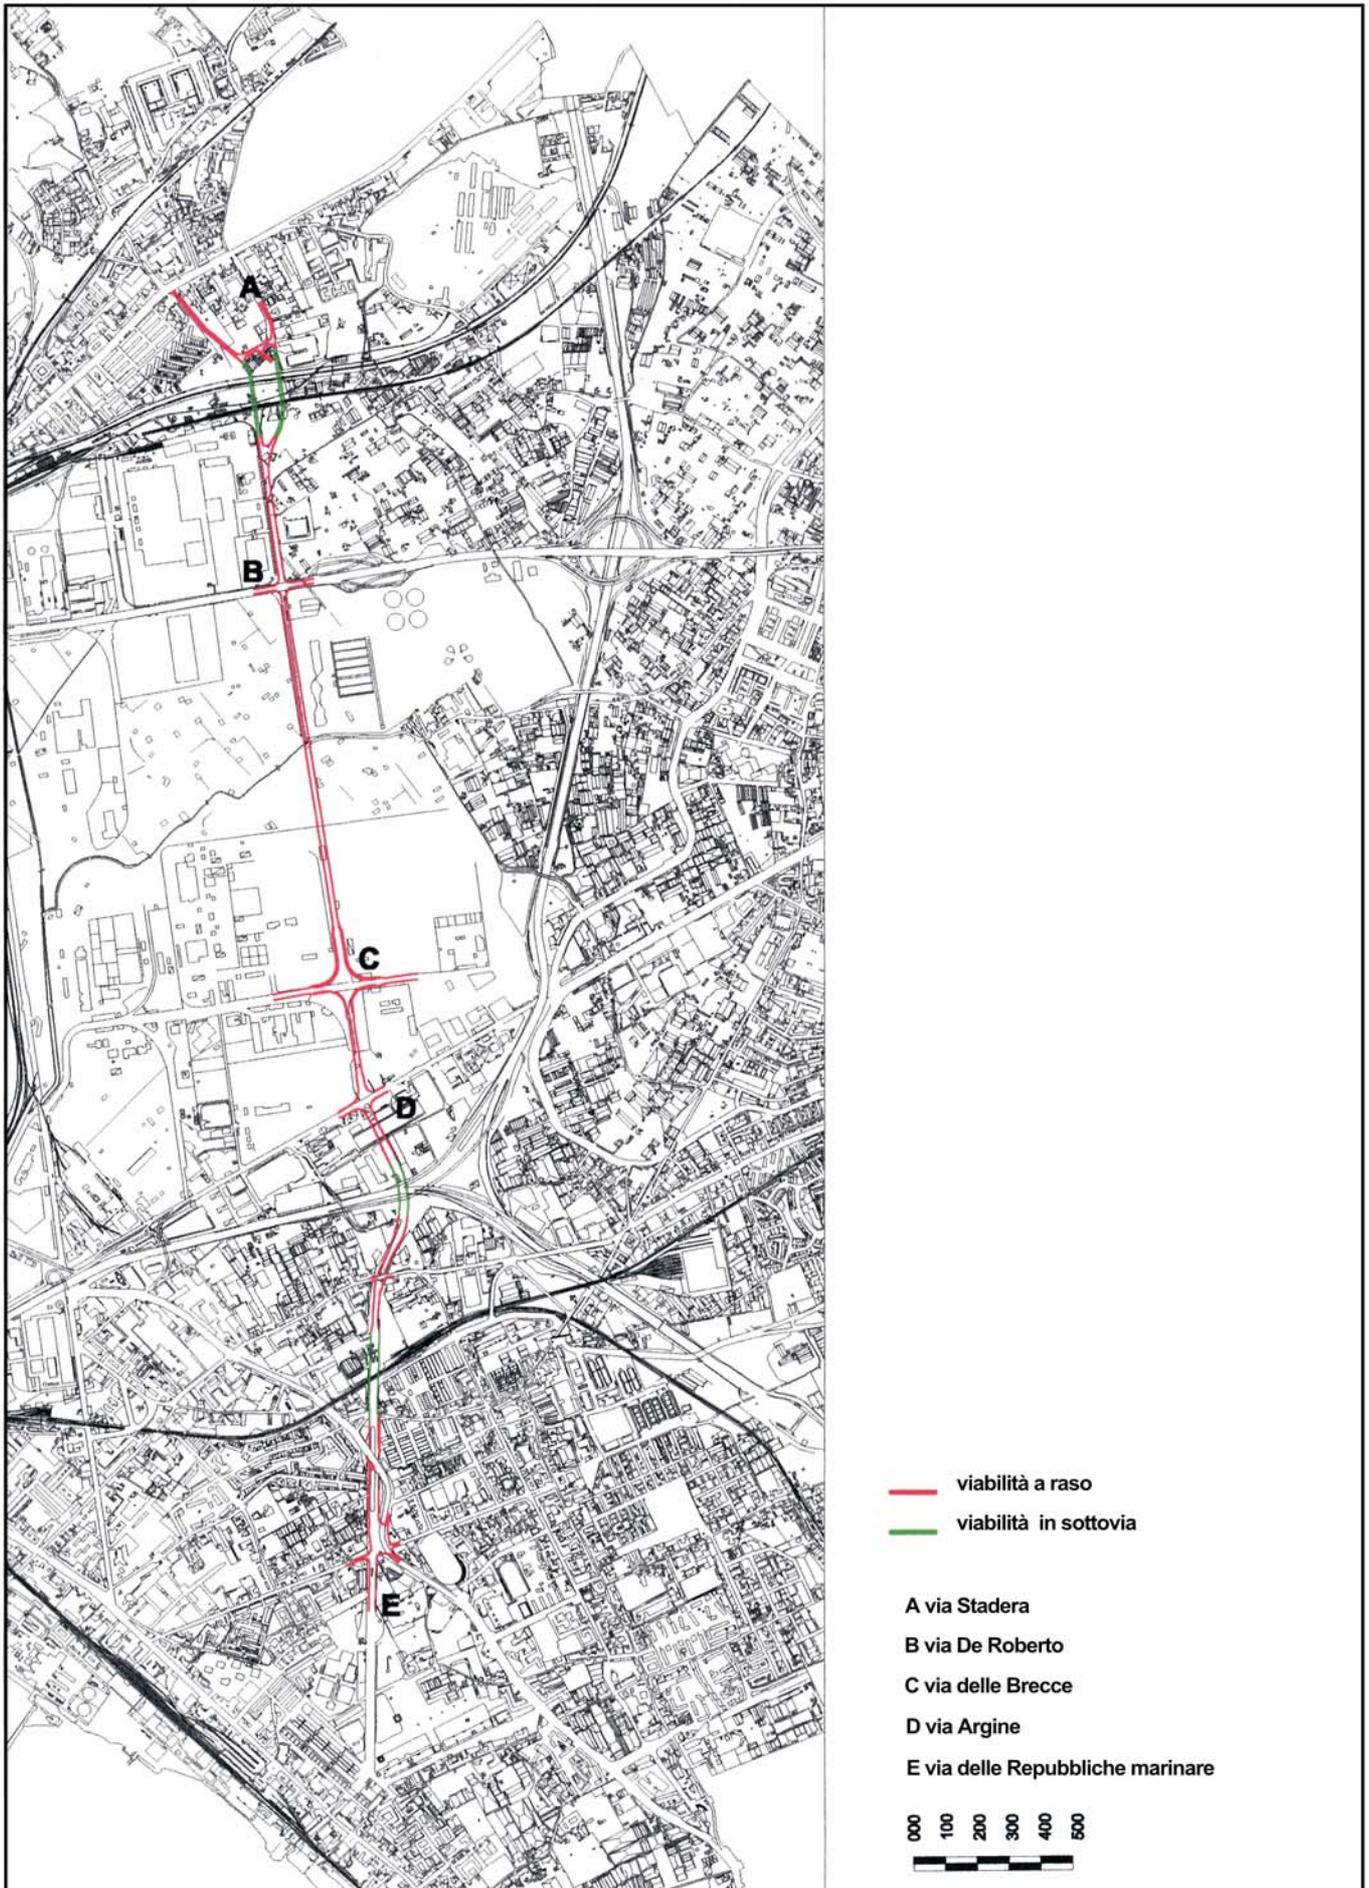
Asse via Stadera-via delle Repubbliche Marinare. Planimetria
